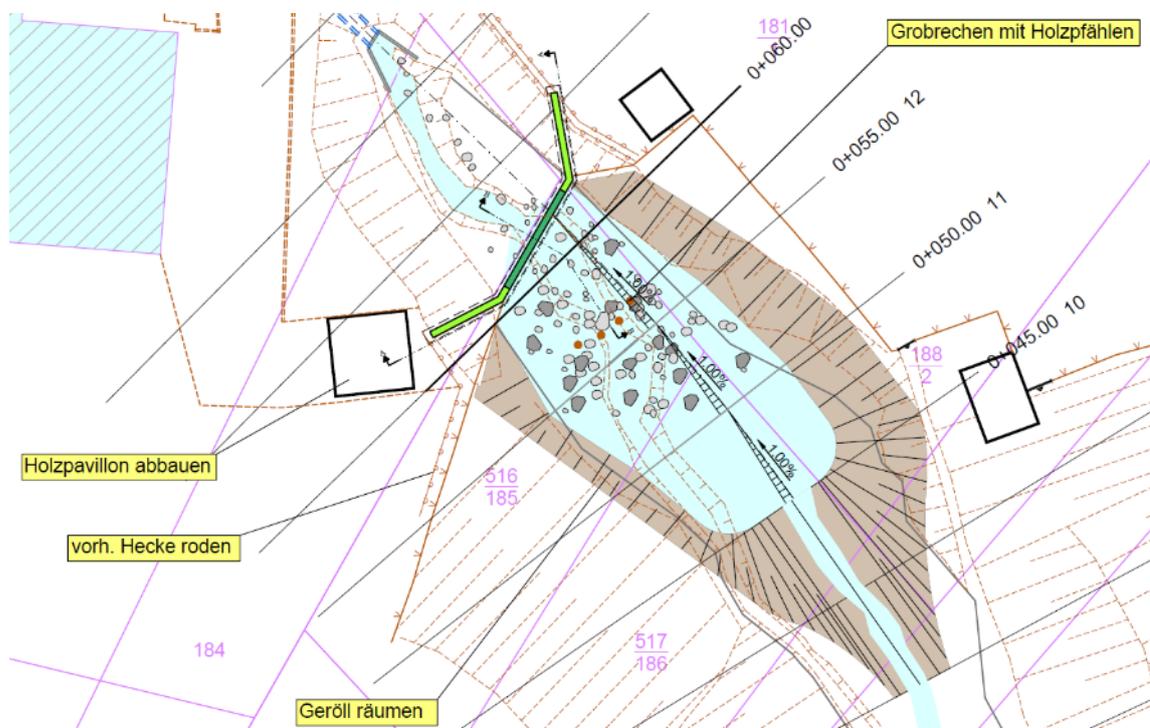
Lageplan gepl. Drosselbauwerk Scheidkopfbach vor Nitztal
